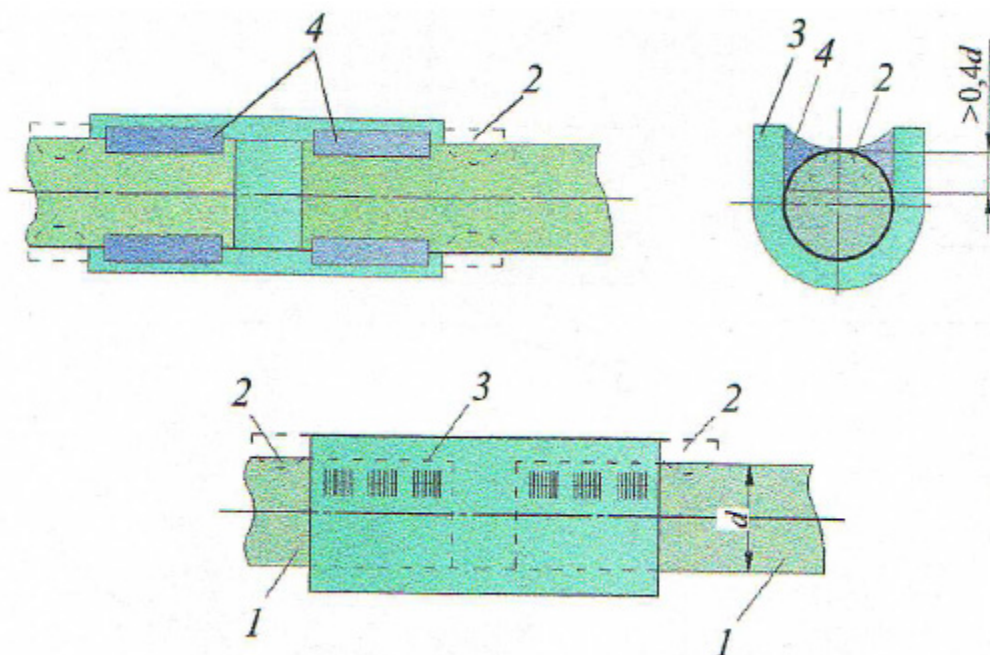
Соединение стержней с помощью ванно-шовной сварки:
